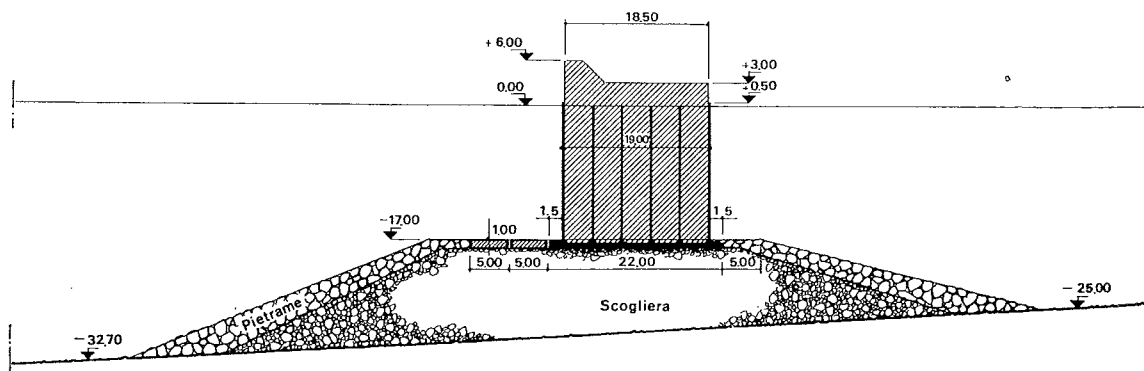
PORTO DI GENOVA-CORNIGLIANO. Diga braccio di Levante.
